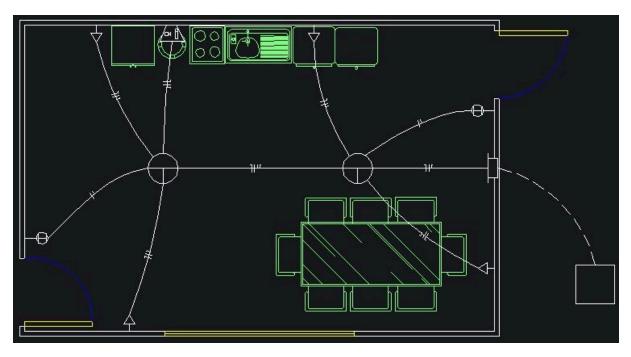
Planta baixa de uma cozinha feita no BricsCAD.
